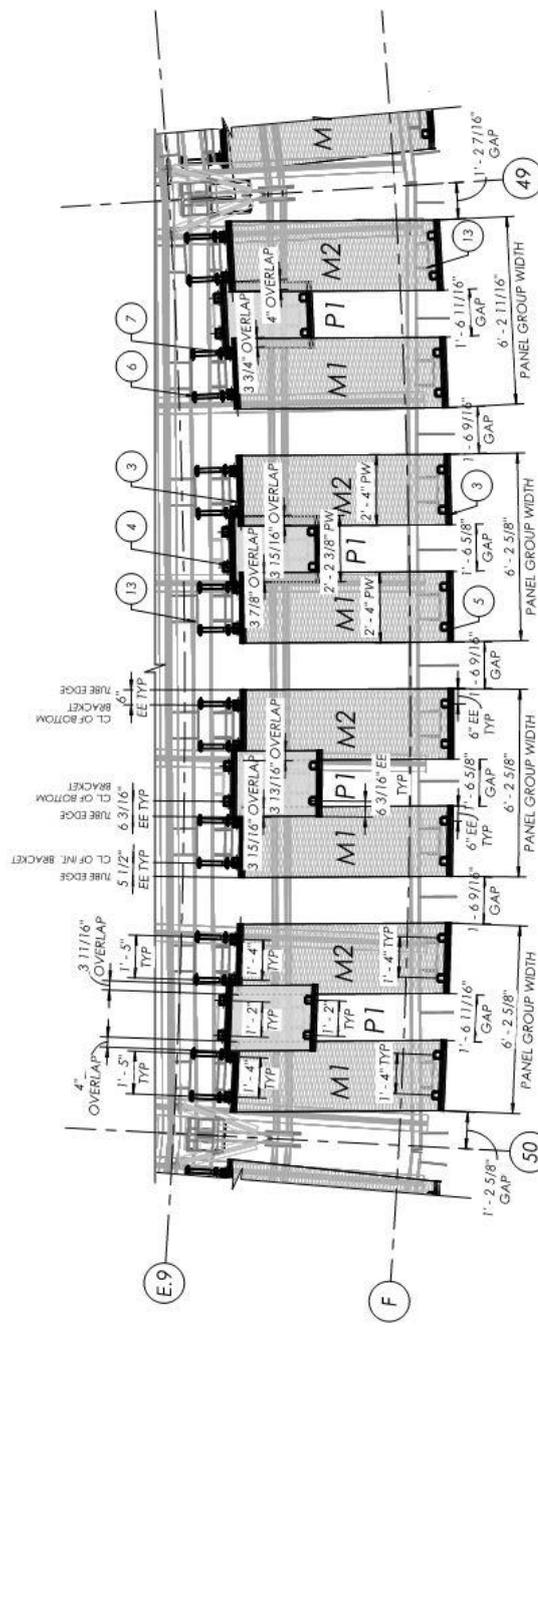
Planta agrandada de una bahía de la zona noreste
